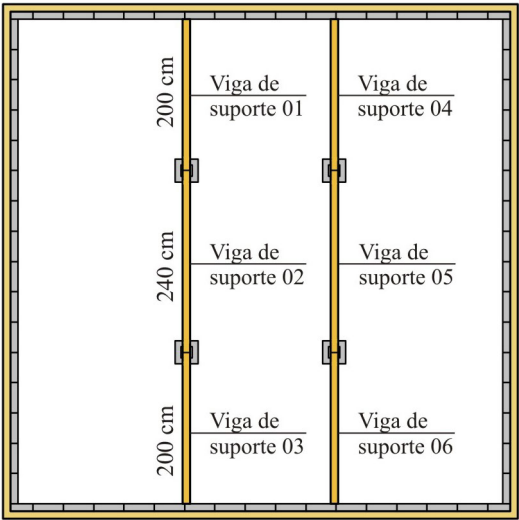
Visualização em planta da soleira e das 06 vigas duplas de suporte
